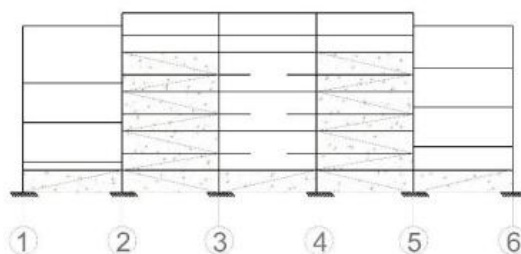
Muro de corte en el pórtico D entre los ejes 2-3 y 4-5. Fuente: Roberto Aguiar (2019)
